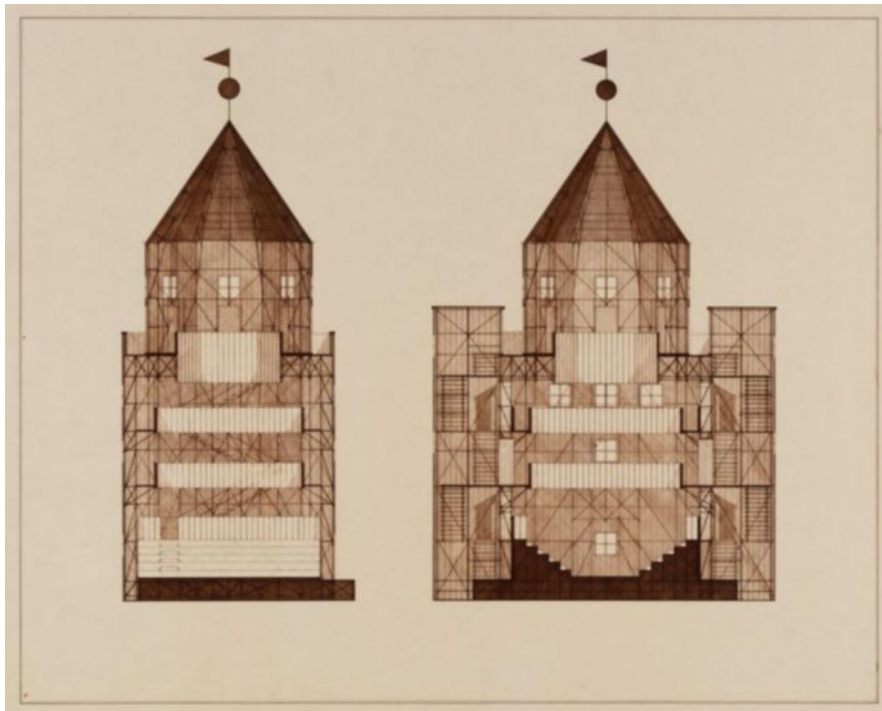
Sezioni in elevazione del "Teatro del mondo" di Aldo Rossi, Fondazione Aldo Rossi, Venezia, 1979-1980.
